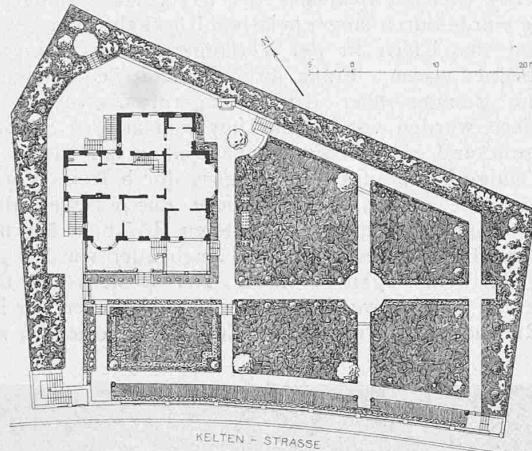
Lageplan des Hauses zur «Sunnehalde» — 1 : 800.
